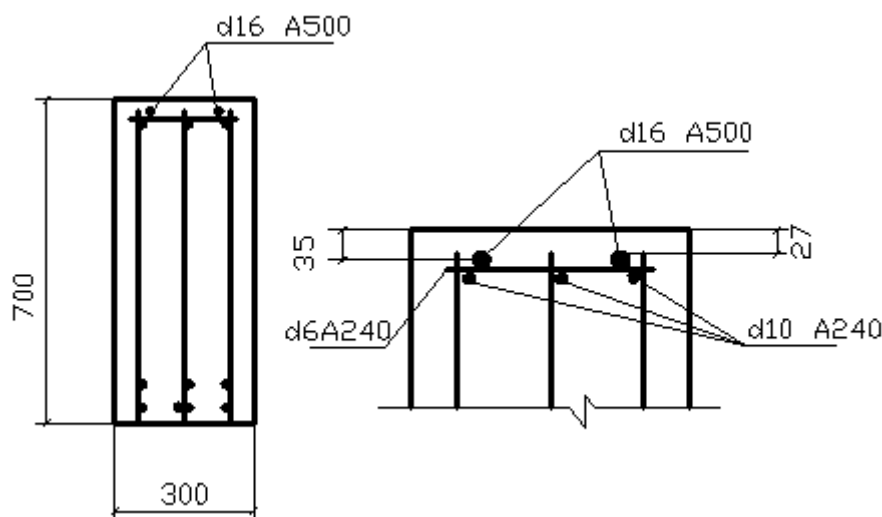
Размещение рабочей арматуры на опорах ригеля
